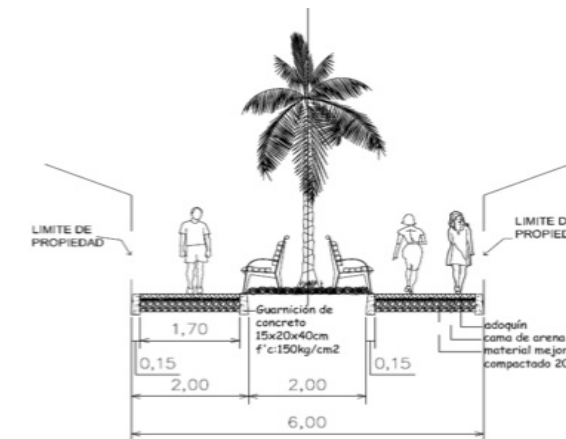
Sendero tipo D: Sección con Jardín Central. Fuente: EPYPSA, 2012.
